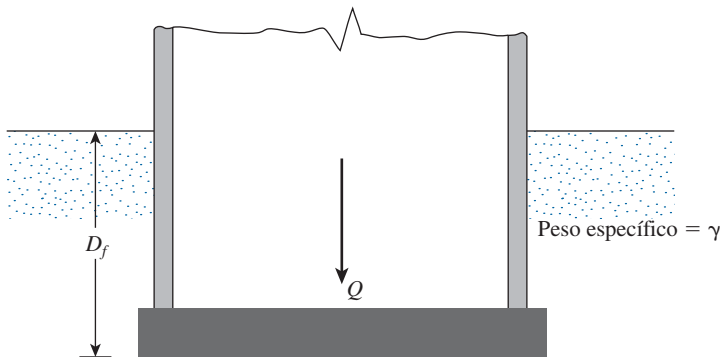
Definición de la presión neta sobre el suelo causada por una losa de cimentación.
